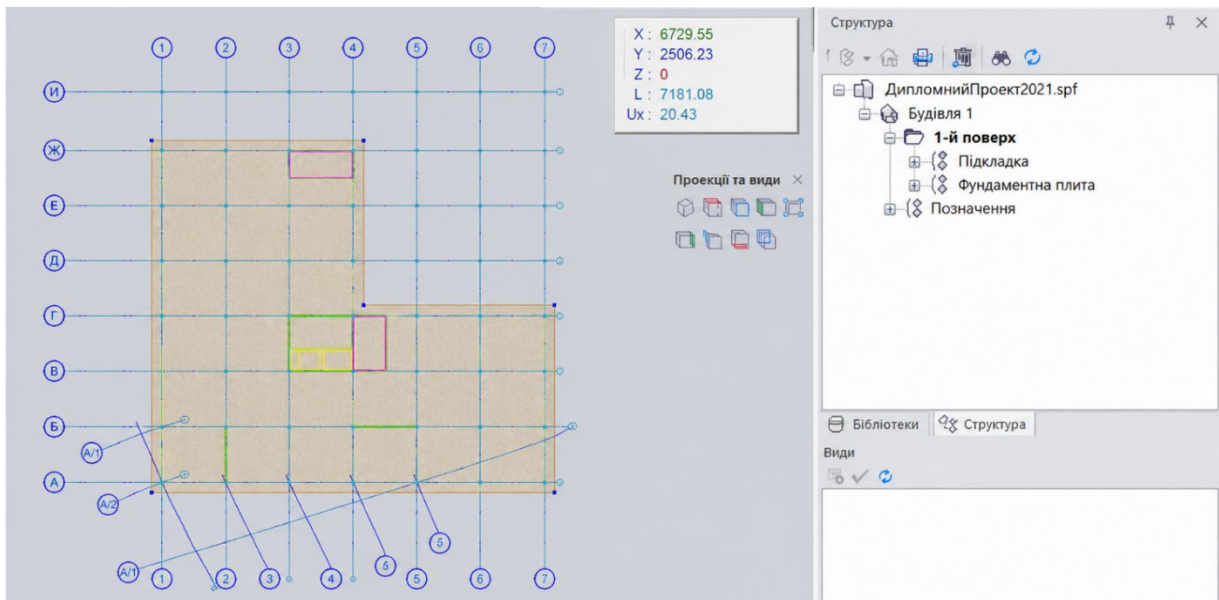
Побудова контурів фундаментної плити в ПК ЛІРА-САПР
